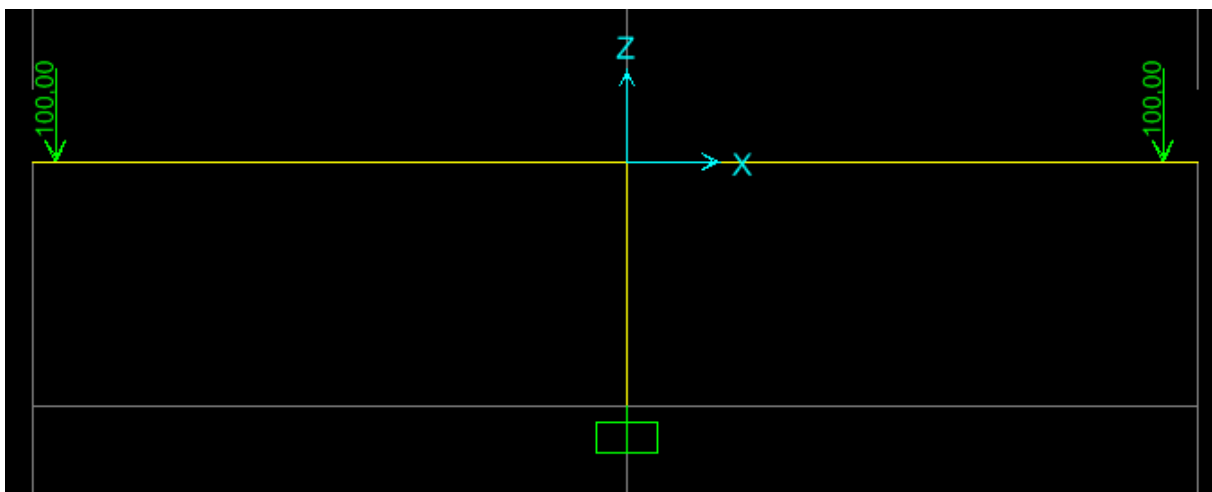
Estado de cargas crítico para el puente en etapa constructiva.
